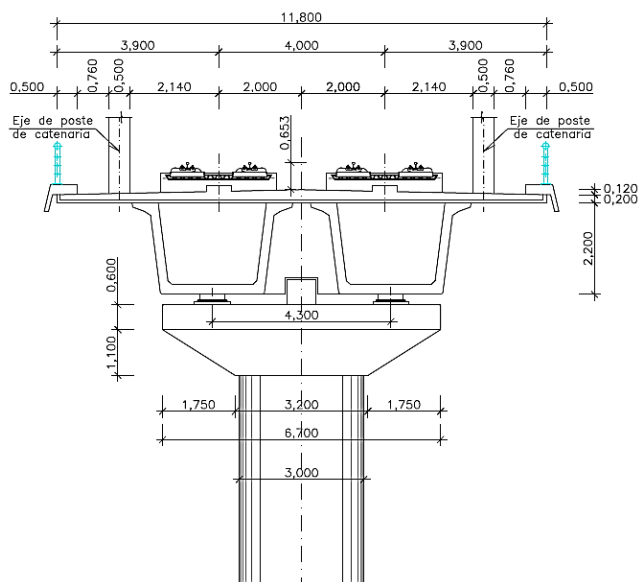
Sección transversal viaducto prefabricado de alzado de Pila
